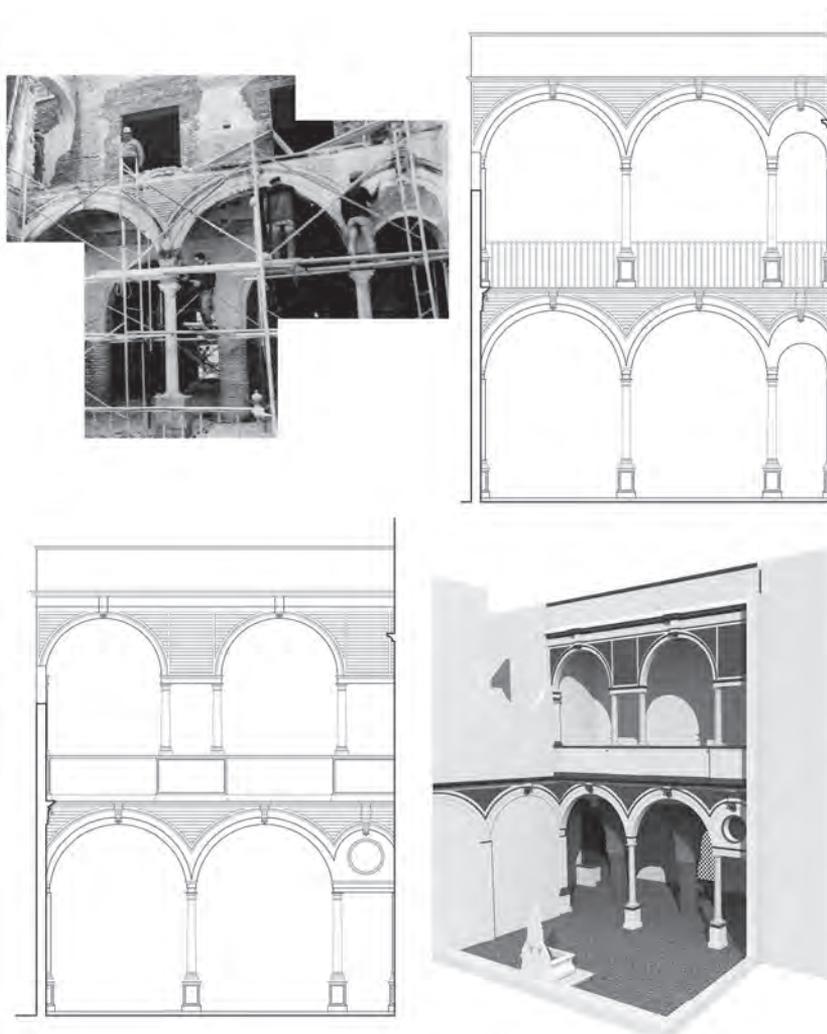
Galería del Patio del Sol. Primer tanteo y solución definitiva para la planta alta.
